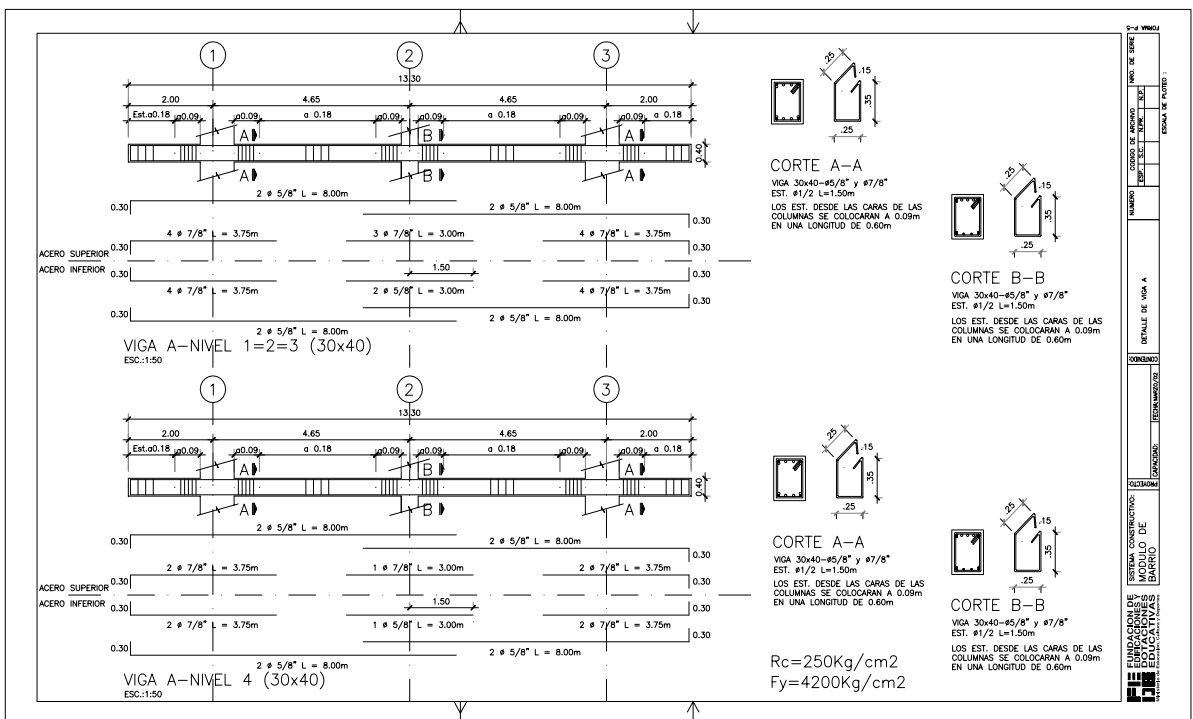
Detalle de viga A. Modulo de Barrio.
